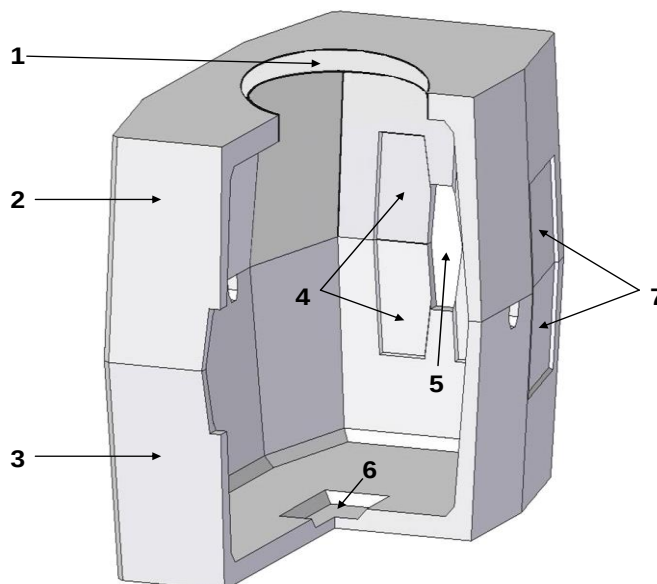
Колодец «ККСр-3-10» в сборе, внешний вид и детали элементов колодца:
